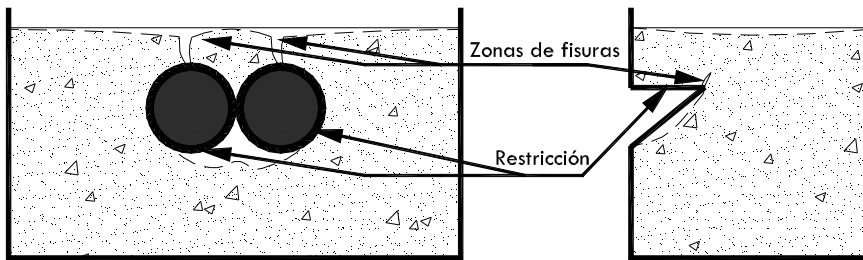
Fisura por asentamiento con restricción (por refuerzo y encofrado o moldura)
